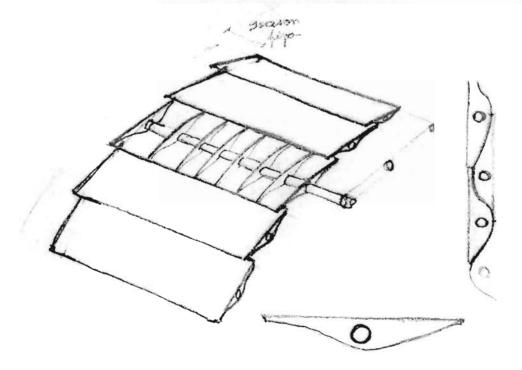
Detalle de la estructura y teselación para el corte de piezas
